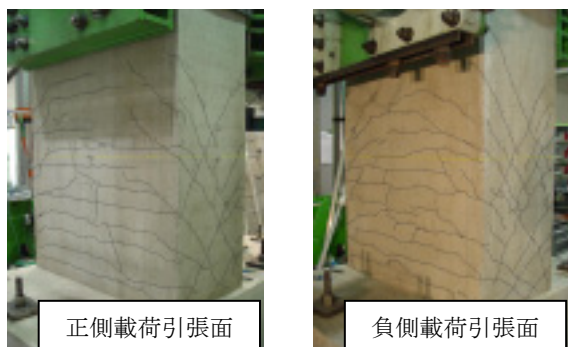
1δ終了時ひび割れ略図(RC-S-1)
